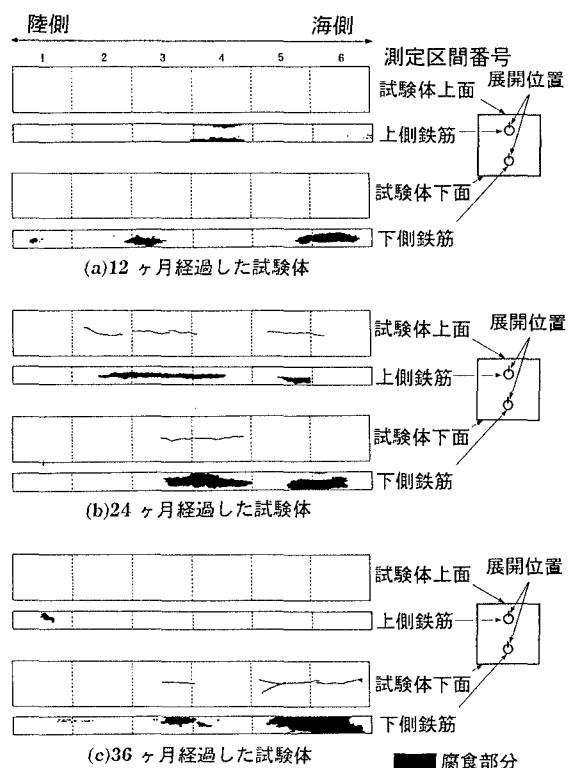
試験体のひび割れ状況と鉄筋の腐食状況
